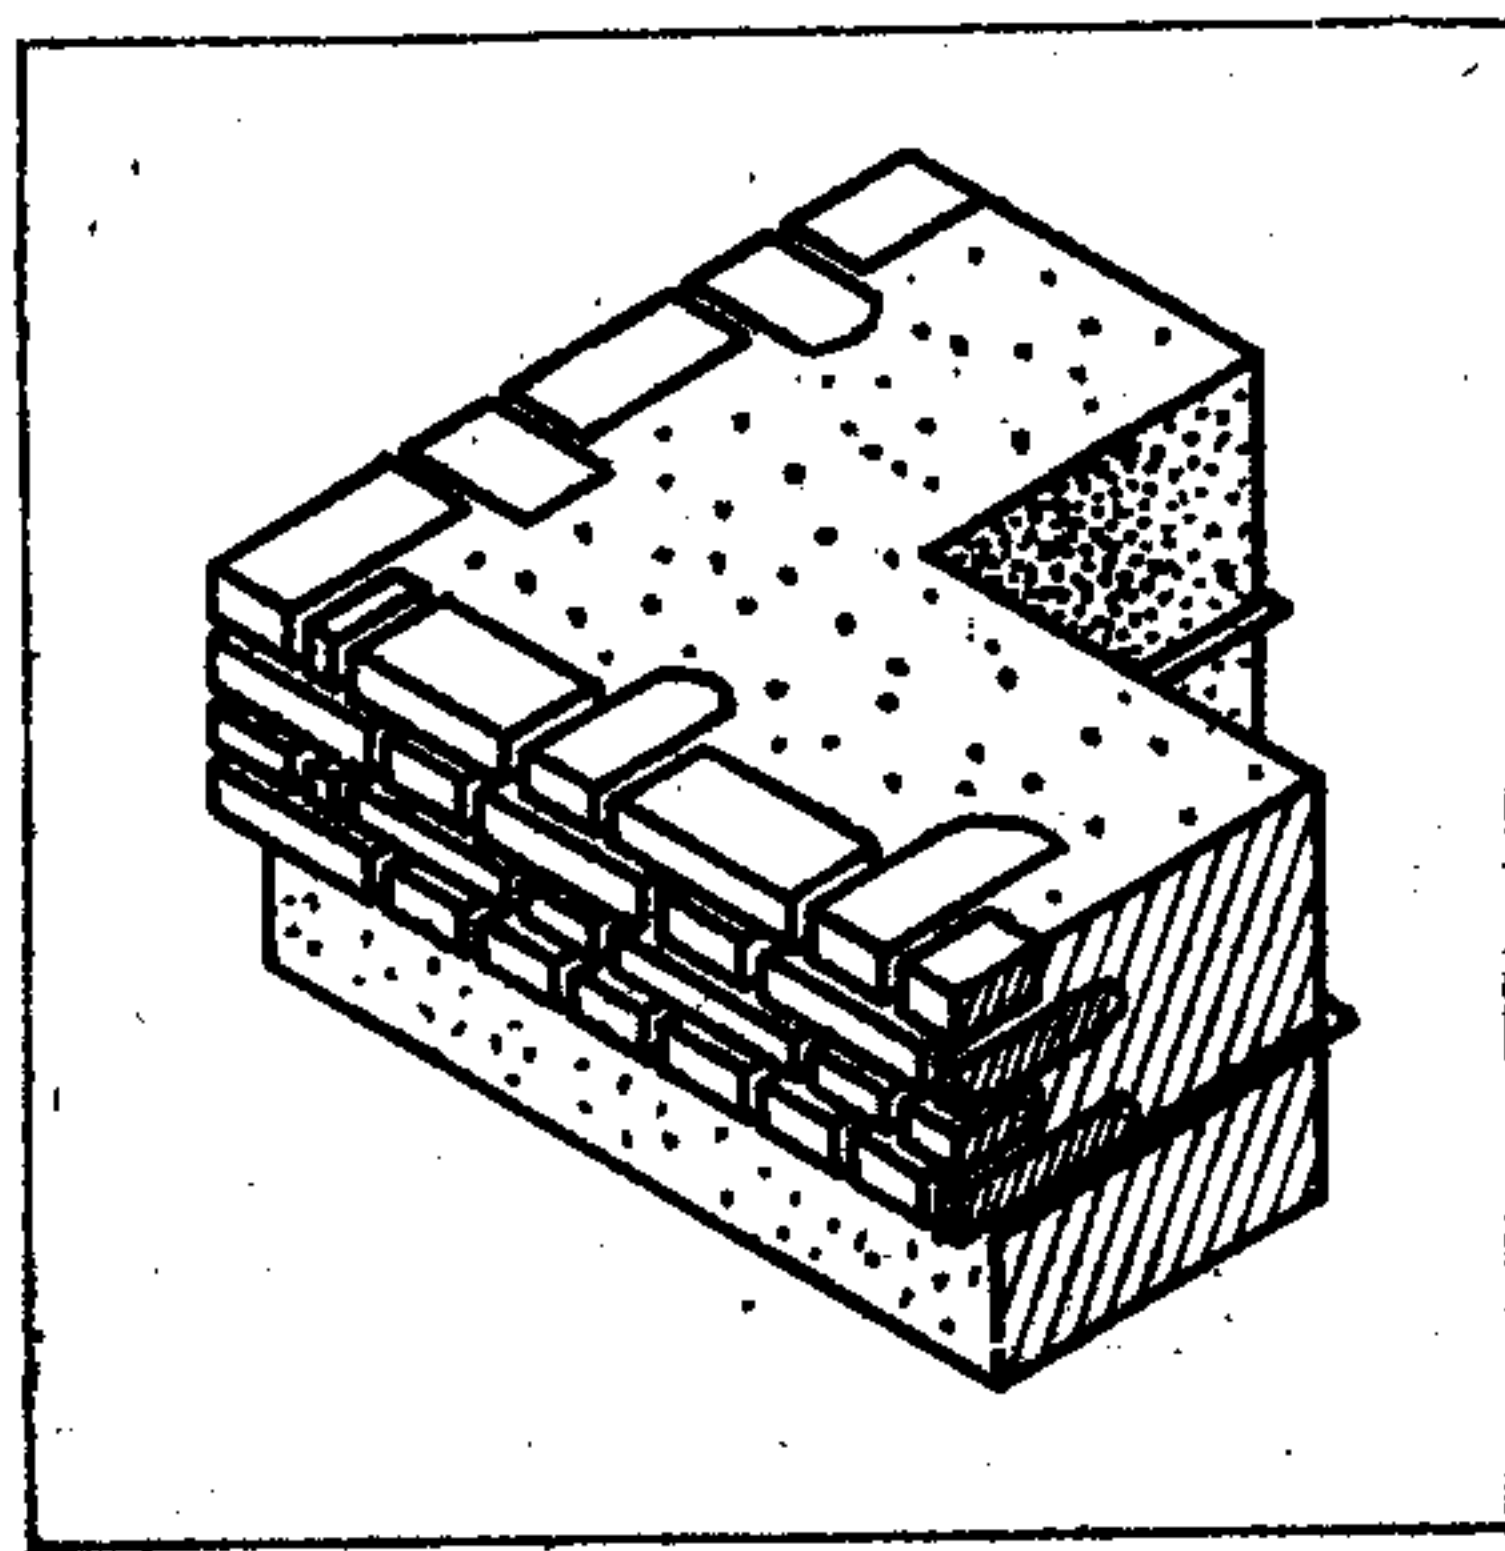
Стены из монолитного шлакобетона с кирпичной облицовкой
